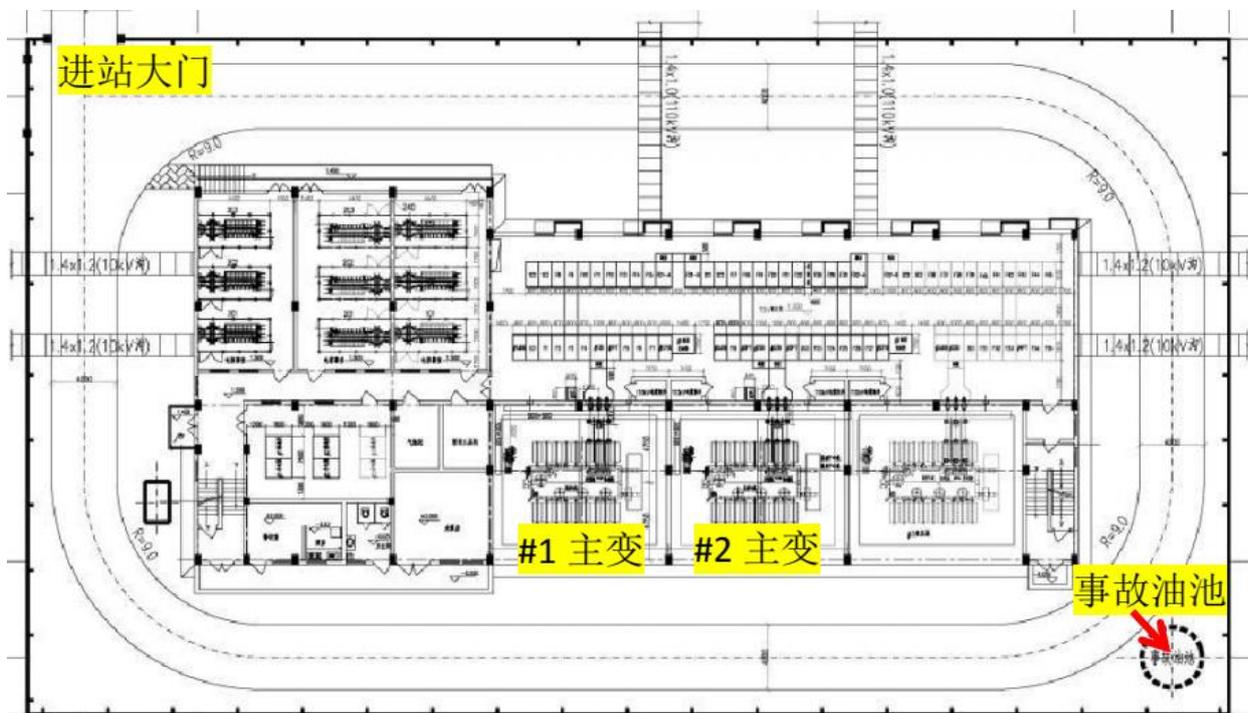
惠州 110 千伏曙光变电站总平面布置示意图
